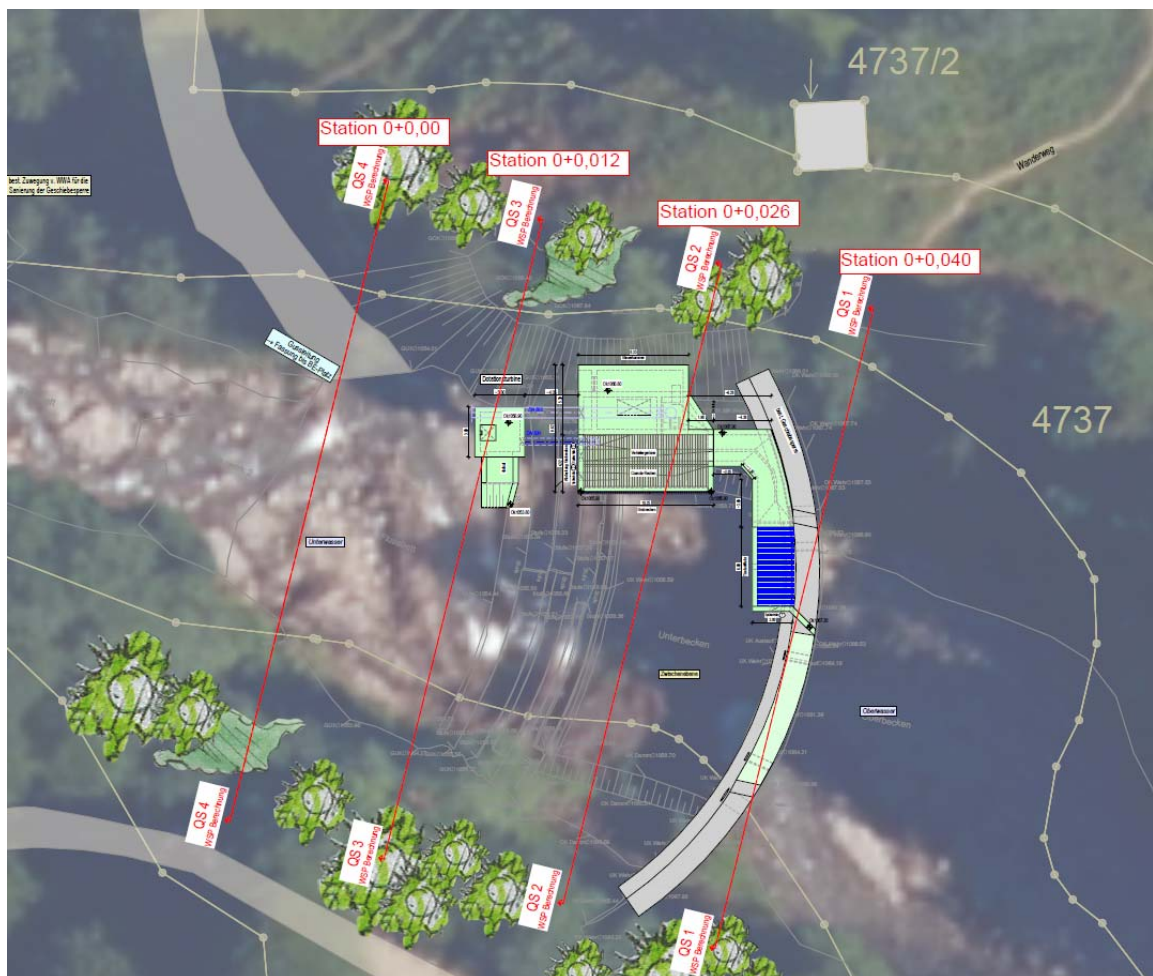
Lageplan aus der Vermessung mit eingetragenen Querprofilen
